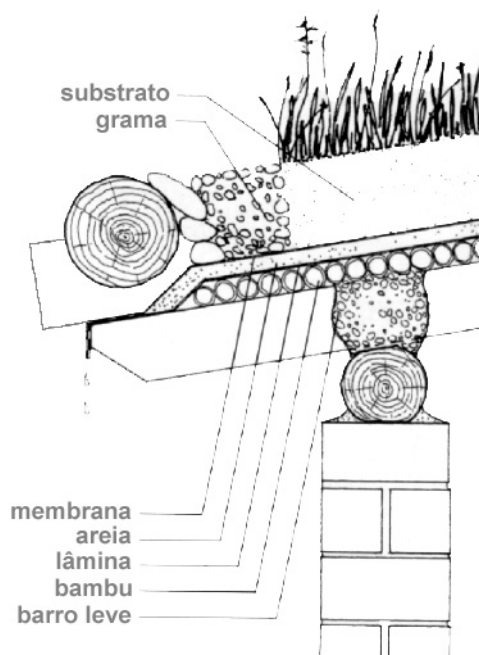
detalhe construtivo da cobertura (MINKE, 2004)
